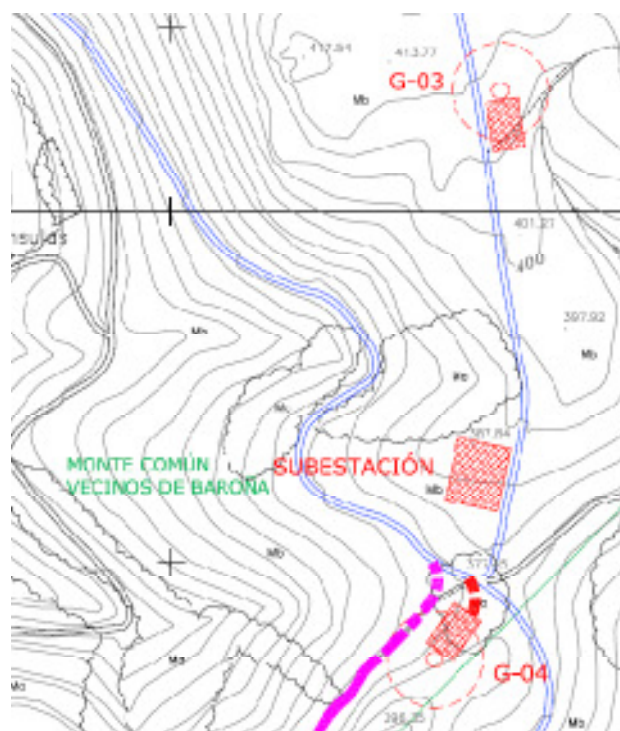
Layout do parque eólico com a infra-estrutura planeada
